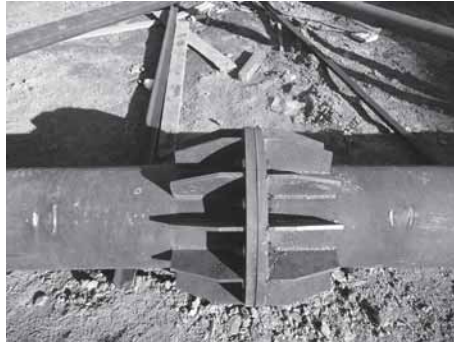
Монтажне з'єднання нижнього пояса ферми конструкції на будівельному майданчику
